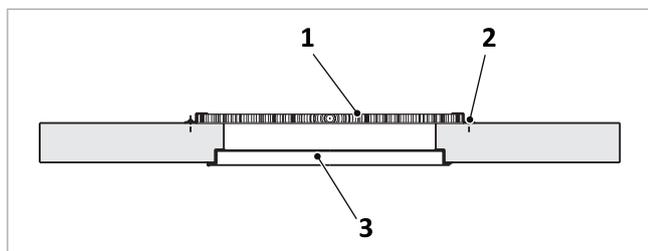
Pelletlagerraumtür – Ansicht von oben
